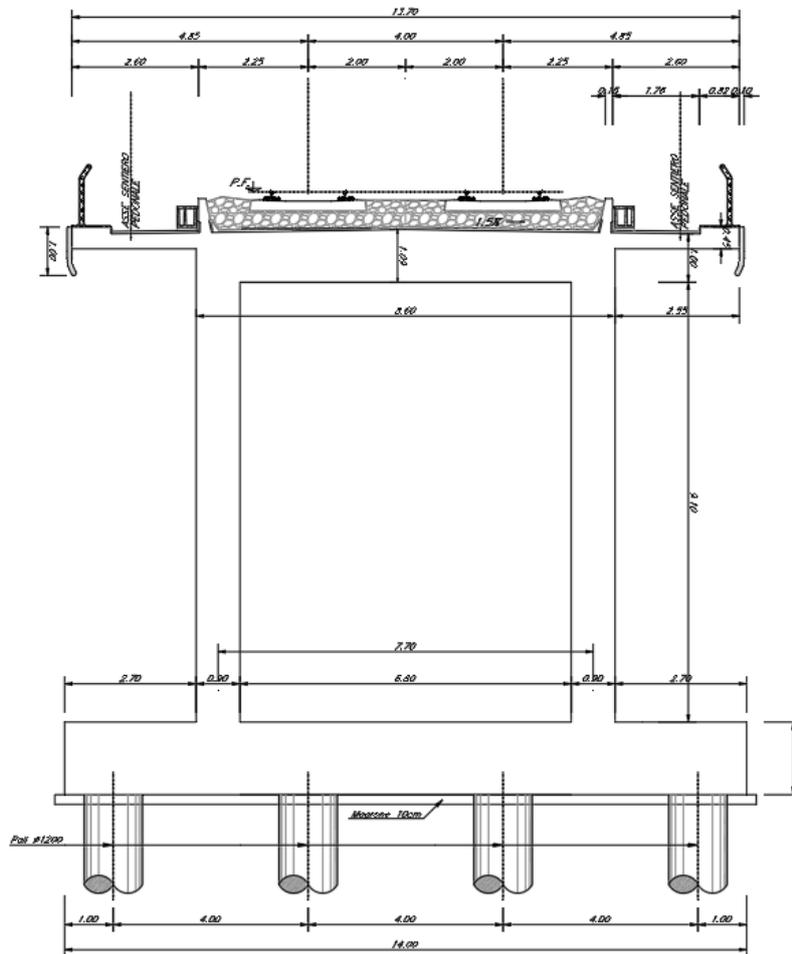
Sezione tipo del manufatto senza setto trasversale
